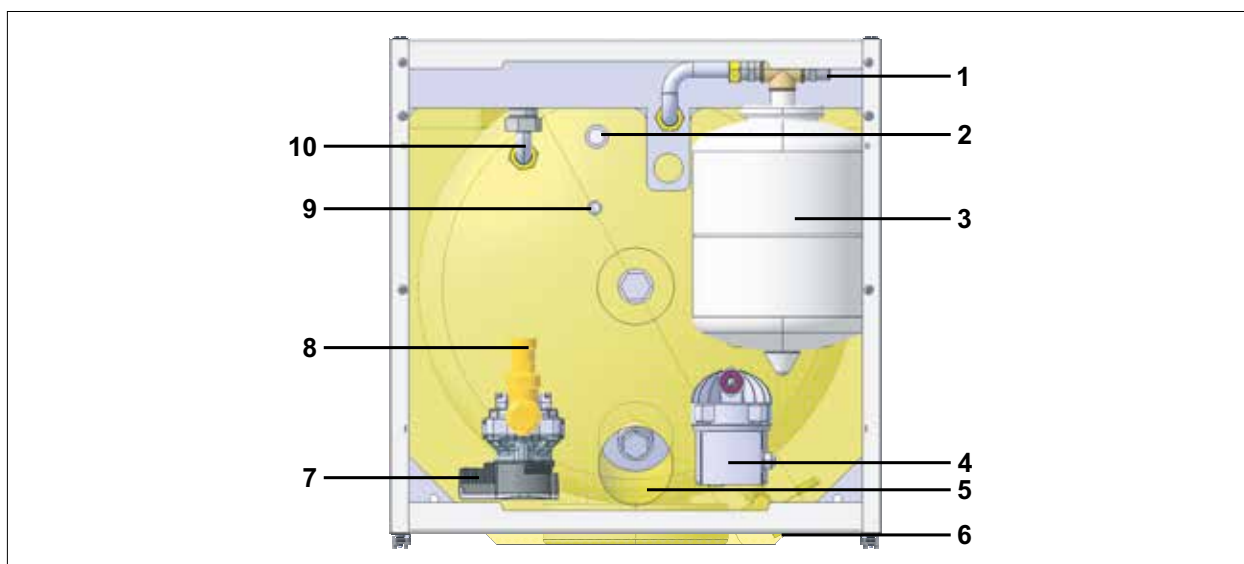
Детали водонагревателя косвенного нагрева TR
